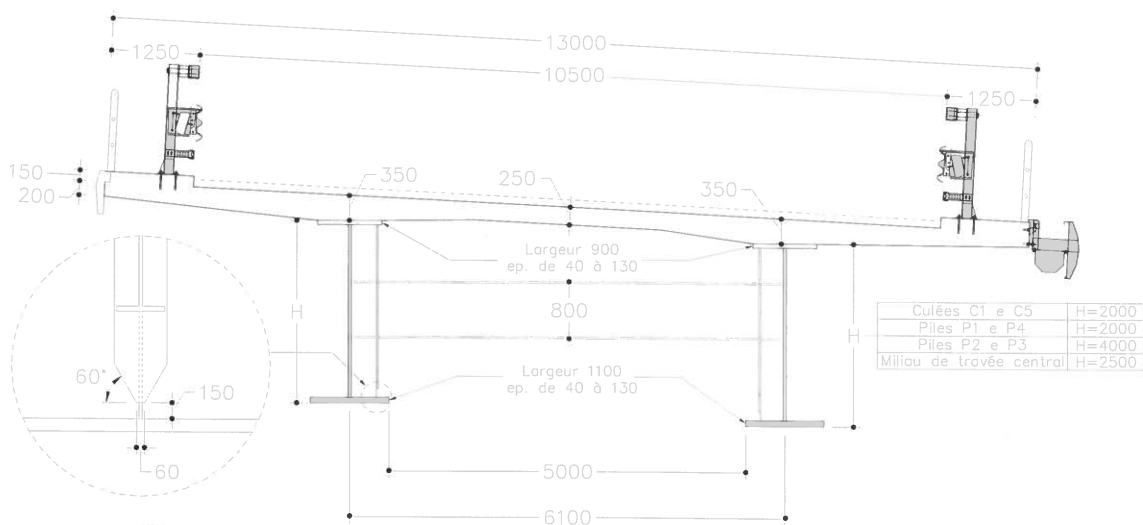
Viaduc Santa Maria : coupe transversale / Deck section
